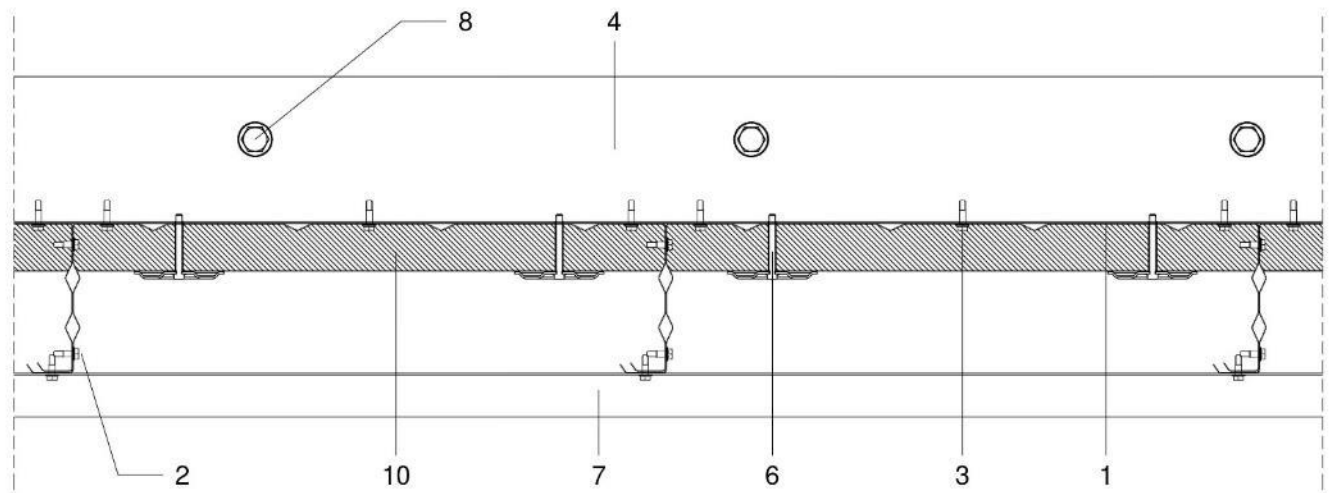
d: Sección horizontal con aislamiento y revestimiento de chapa Atenea en horizontal.
